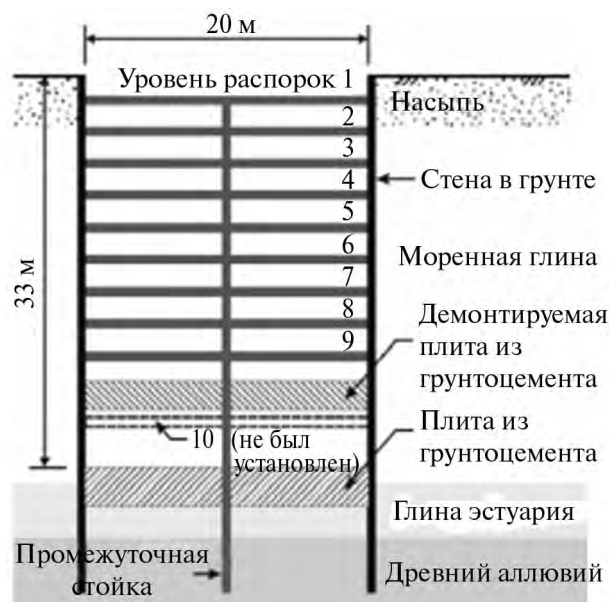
Схема крепления котлована транспортного тоннеля у Никол Хайвей [9]
